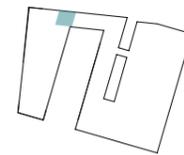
+ 076: Wohnungsgrundrisse EI im Maßstab 1:200
